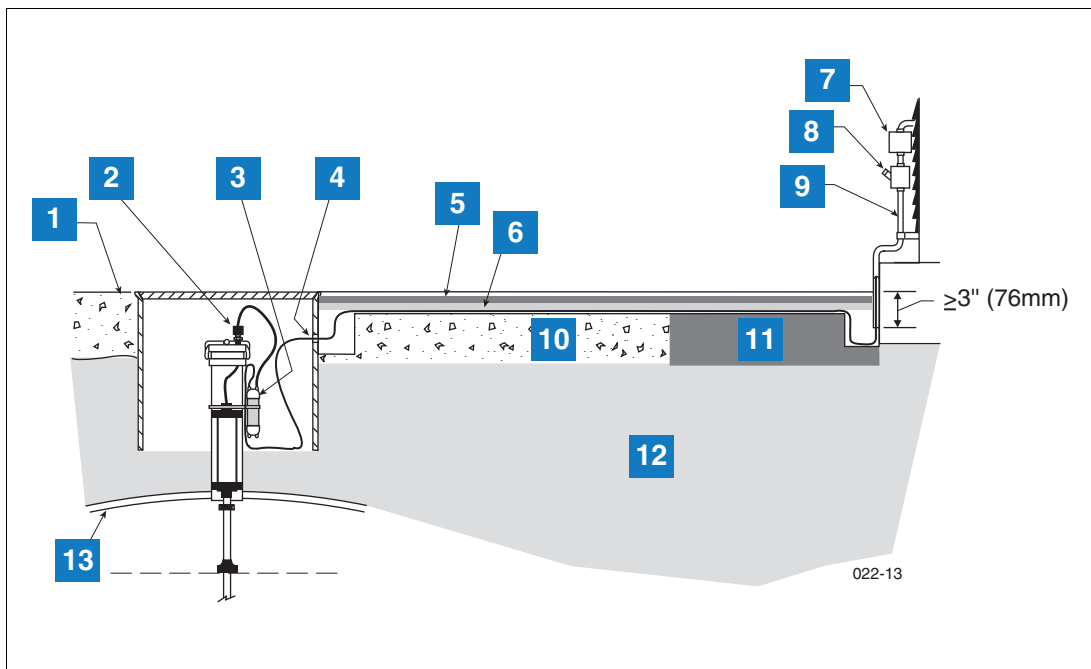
Esecuzione del cablaggio di esempio tramite cavo interrato direttamente
